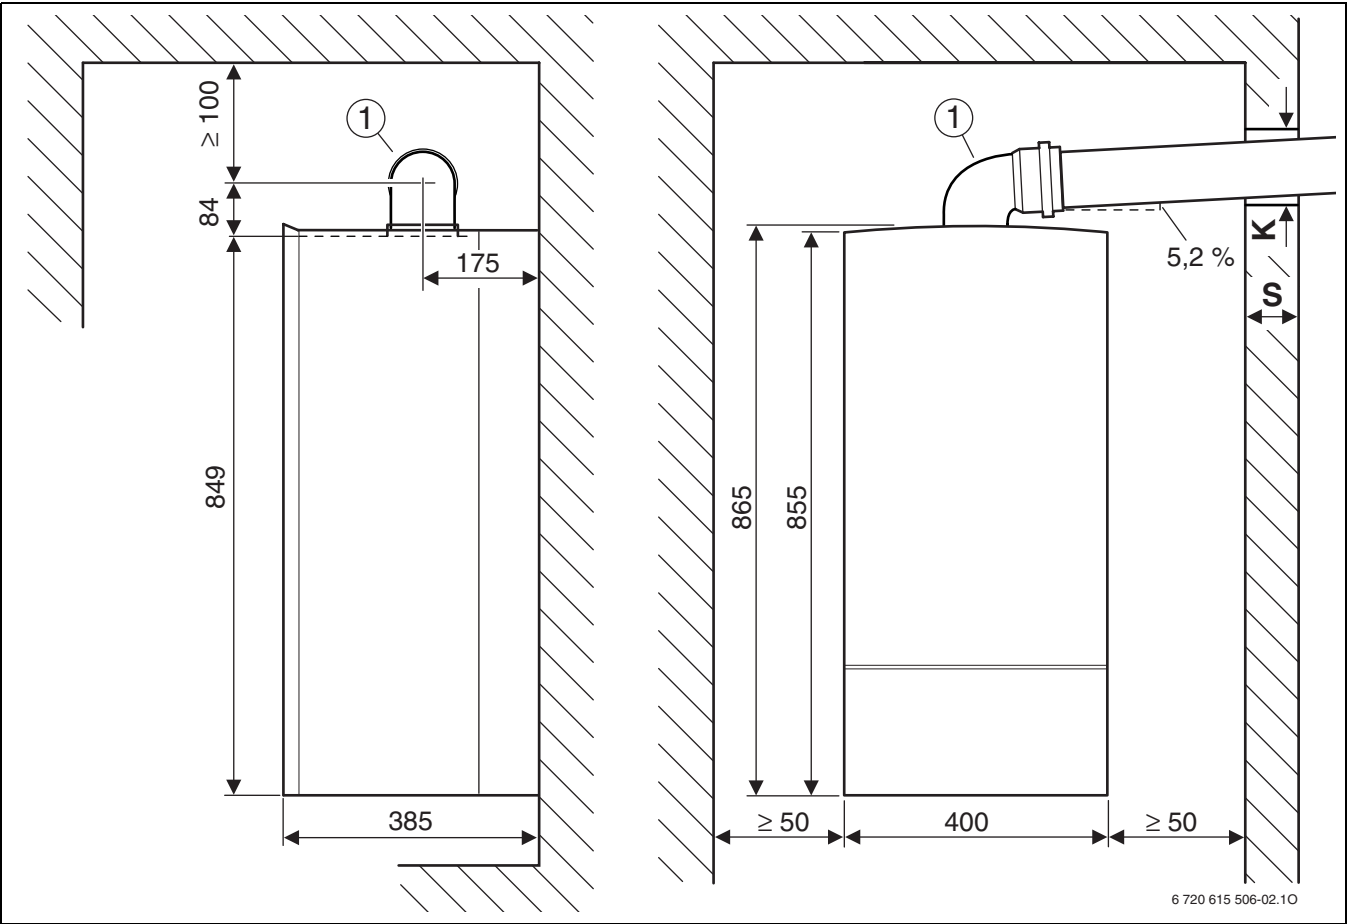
Conduit d'évacuation des fumées Ø 60/100 mm
